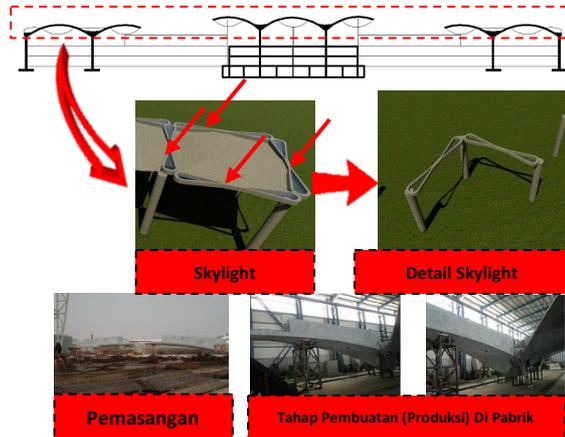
Material Prefabrikasi Bangunan Bandar Udara Kuala Lumpur
